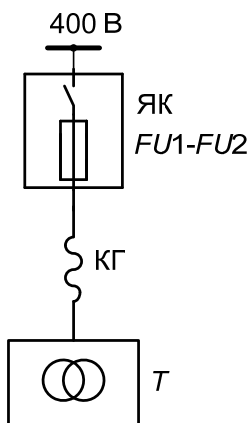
Схема присоединения сварочного трансформатора
